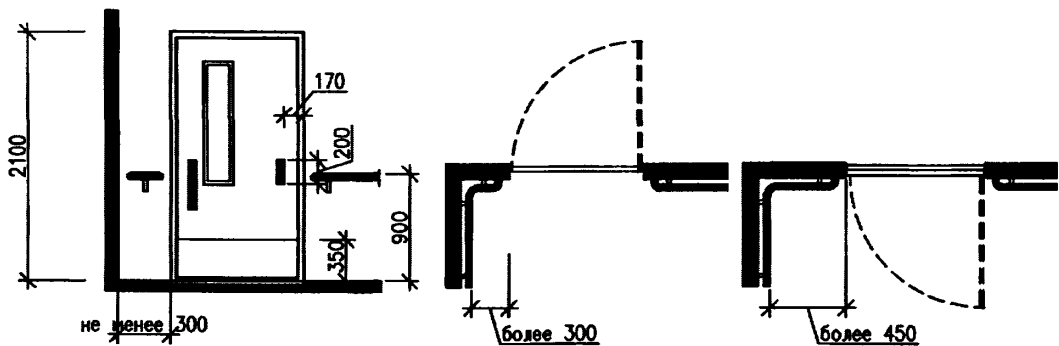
Компонровка дверного проема в угловой части коридора
